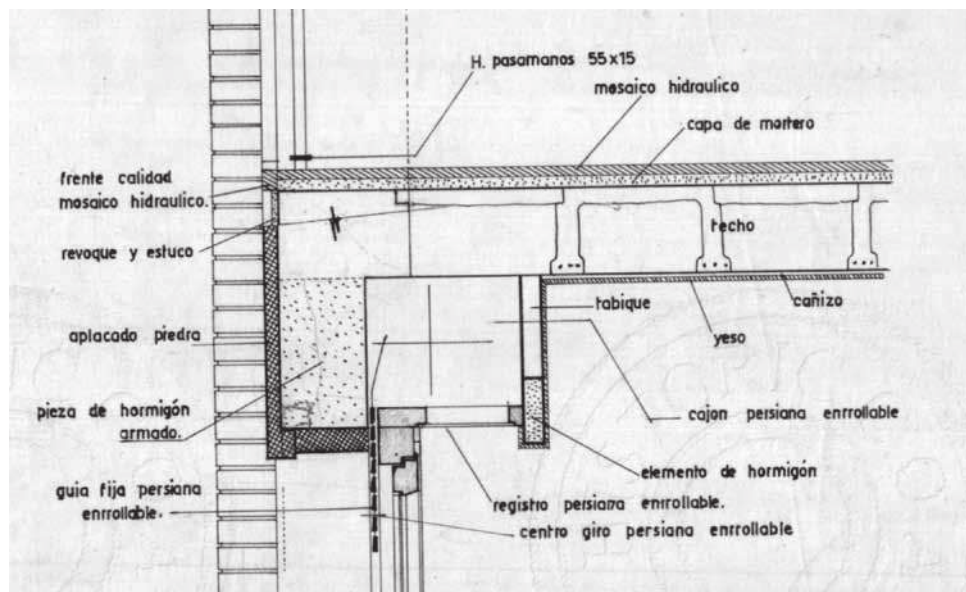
Detalle zuncho de hormigón armado. Edificio Balmes 295 Barcelona. Arquitecto: Lluís Nadal. 1962.
